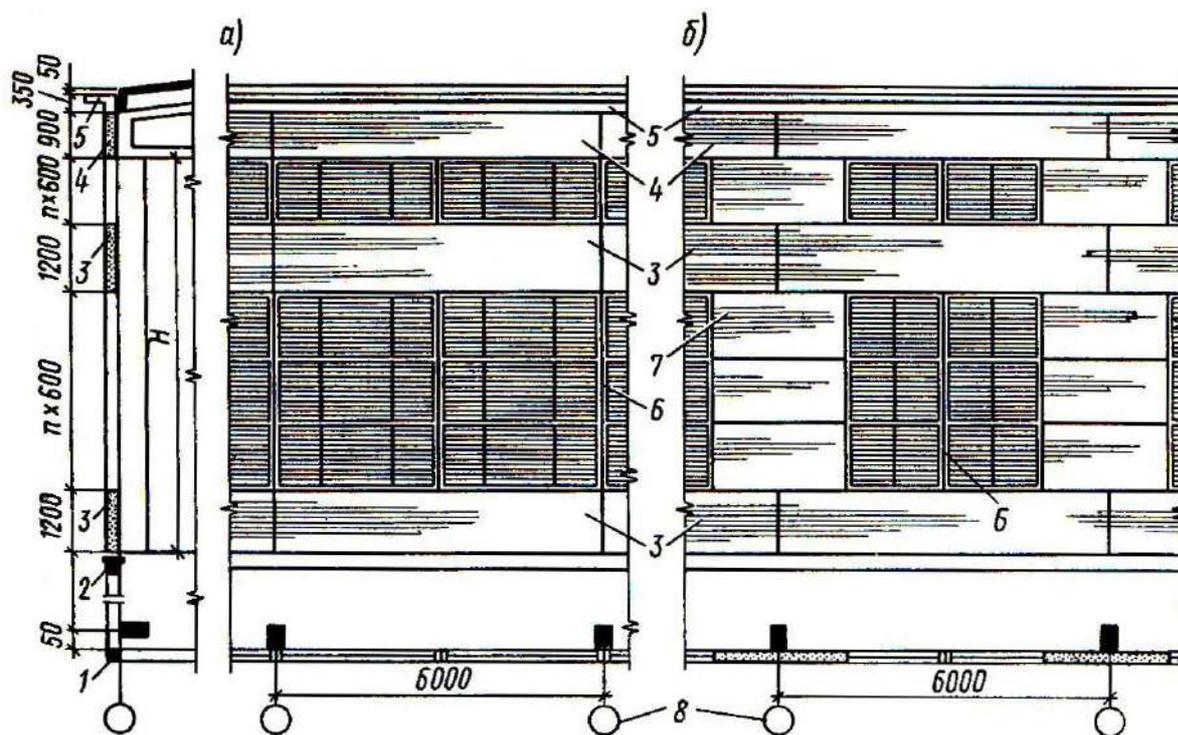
Раскладка панелей продольных наружных стен одноэтажных зданий:
